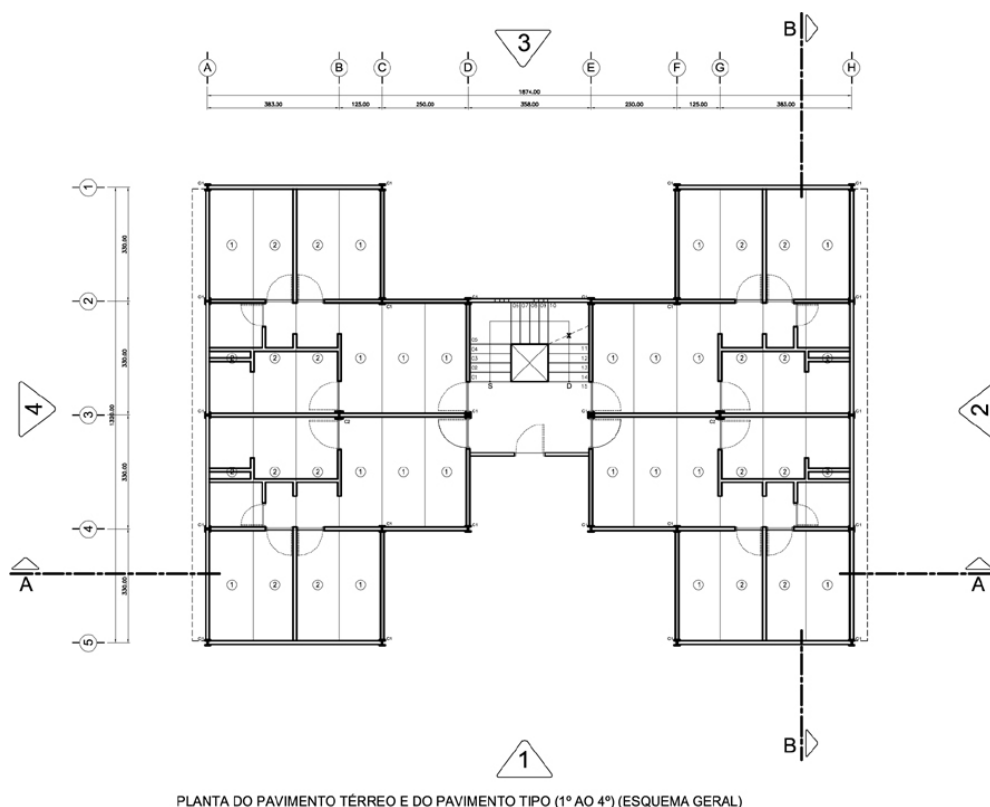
Pavimento-tipo do edifício Camargo Corrêa, com o alargamento da caixa de escada. Fonte CGA USIMINAS
